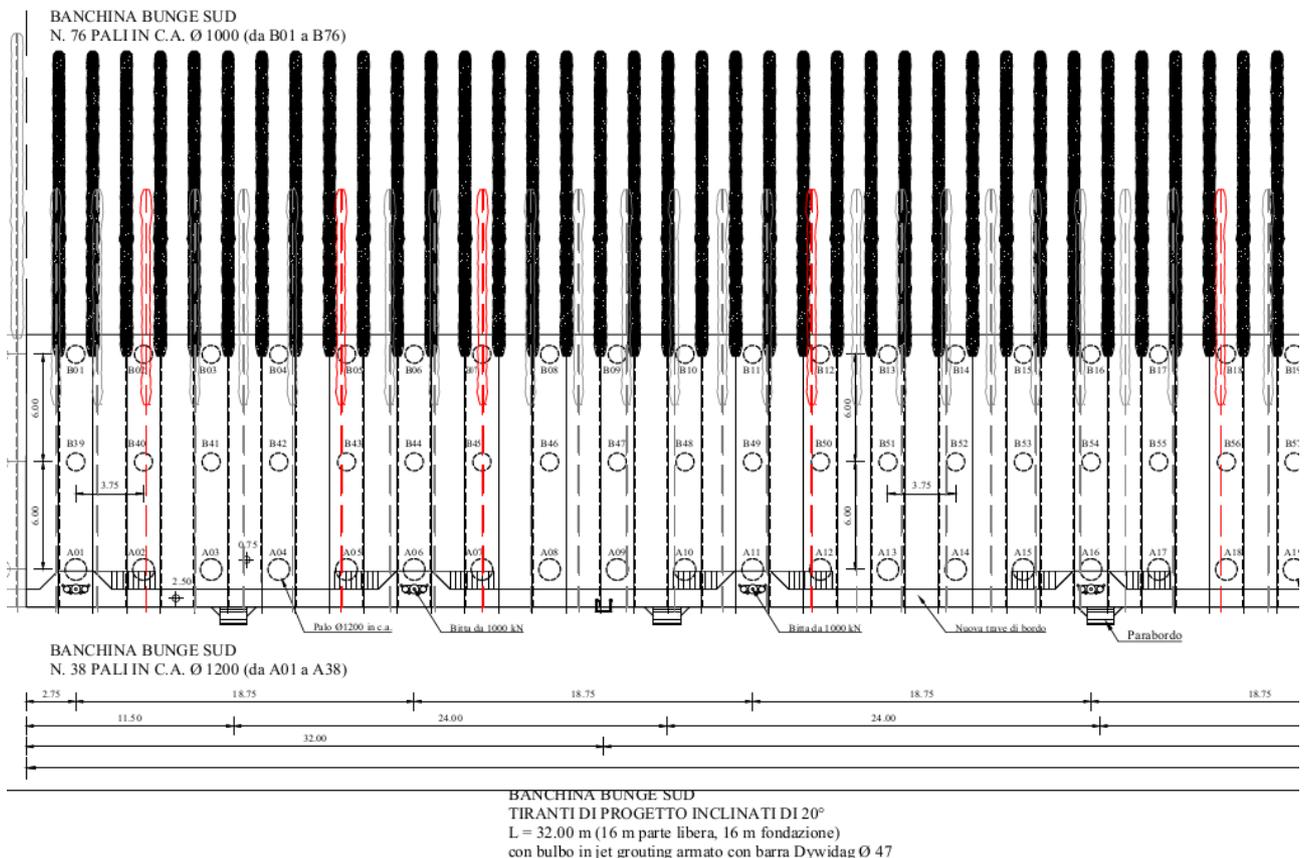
Bunge Sud – Progetto Definitivo – Planimetria intervento
